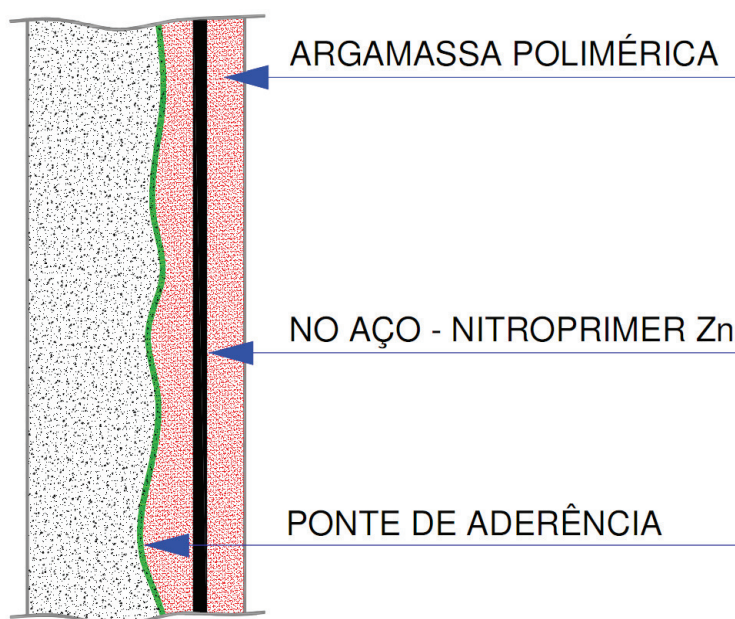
Ilustração do monolitismo e indicação dos componentes da sua estrutura.
